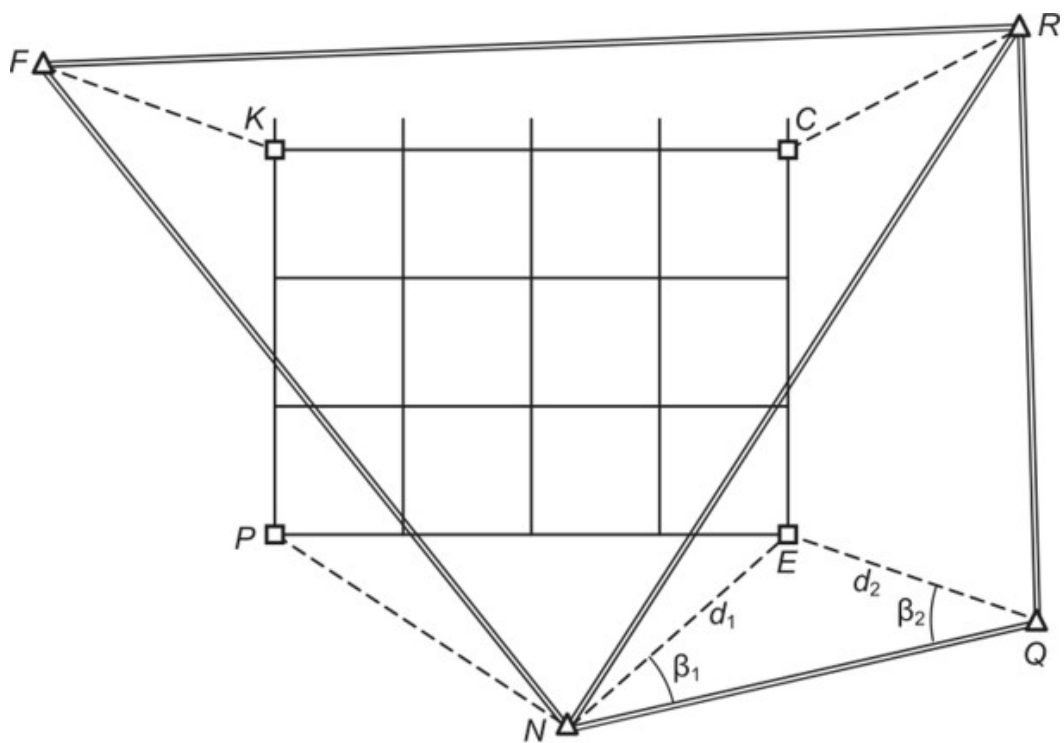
Одна из схем выноса в натуру проекта строительной сетки
